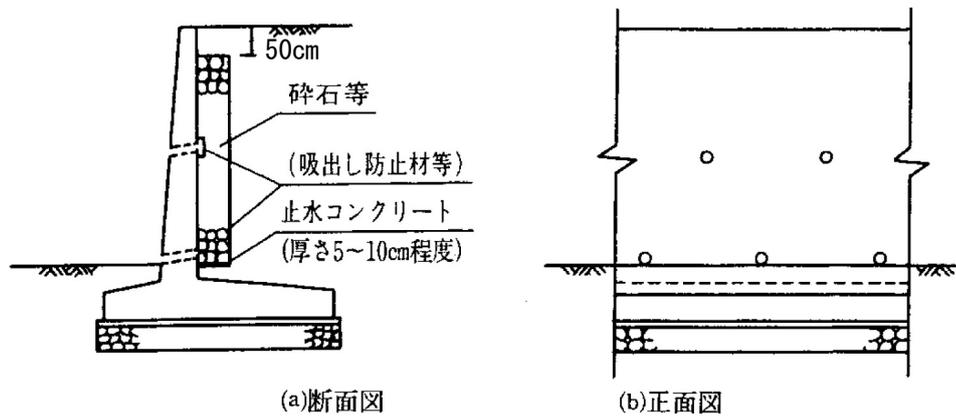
(12)-1 鉄筋コンクリート擁壁の断面図及び水抜穴設置図
